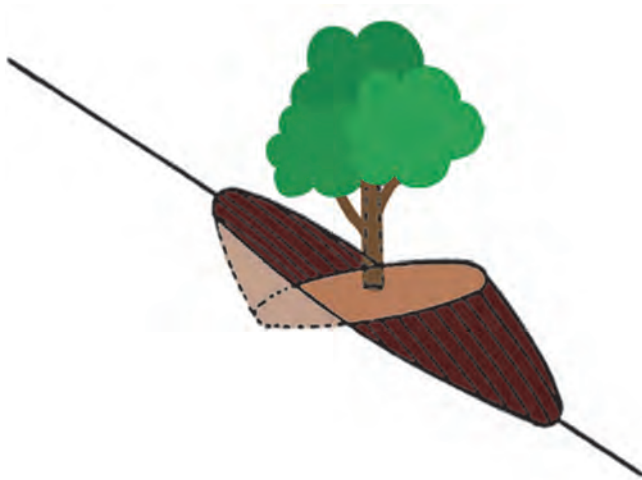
Terraço tipo banquetas individuais para culturas perenes
